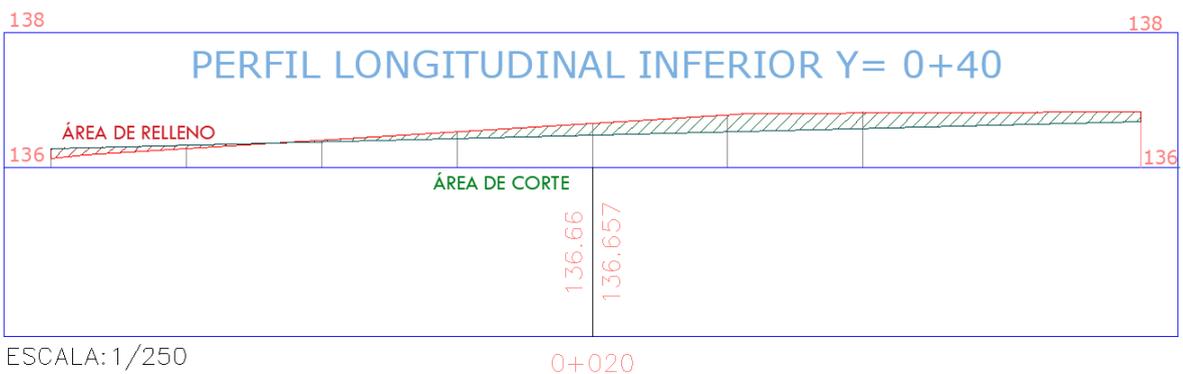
Perfil longitudinal de alineamiento inferior Y= 0+ 040
